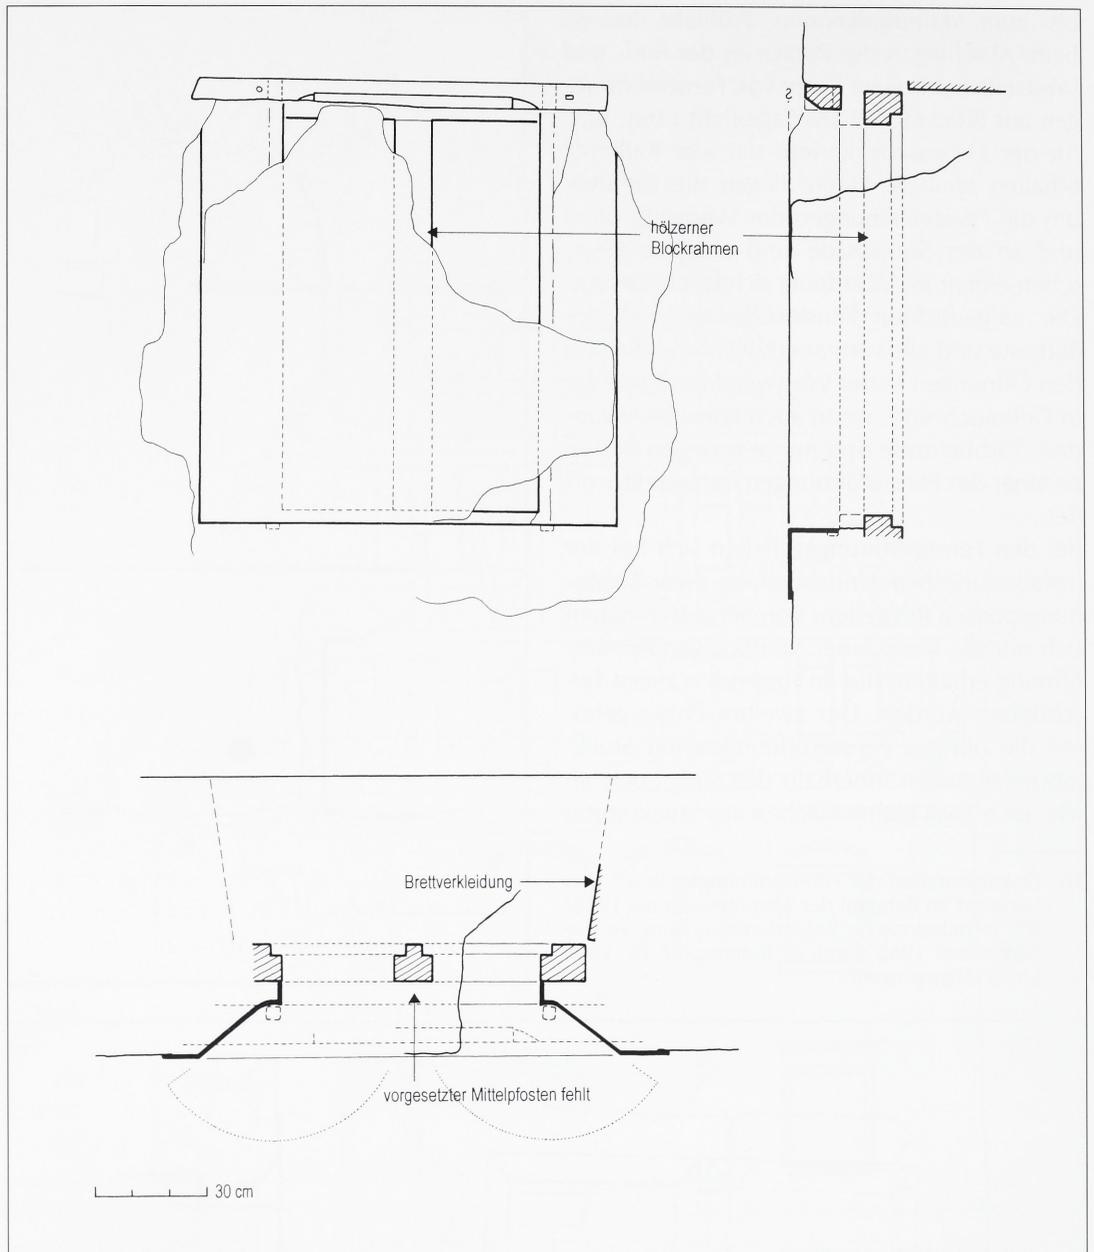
Rottweil, Suppengasse 2. Reste einer Stuckmörtellaibung von einer ehemals mehrteiligen Fensteröffnung, in der südlichen Giebelwand im ersten Obergeschoß mittig gelegen. Außenansicht, Grundriß und Schnitt.
